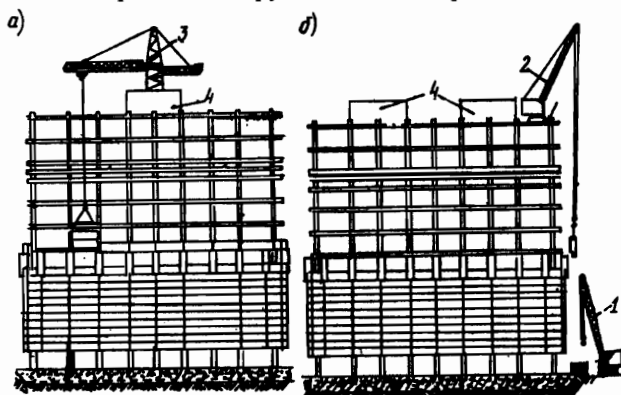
Схема монтажа наружного стенового ограждения с использованием: поворотного оголовка башенного крана на ядре жесткости (а) и крышевого крана (б): 1 - стреловой кран; 2 - крышевой кран; 3 - оголовок башенного крана; 4 - ядра жесткости
